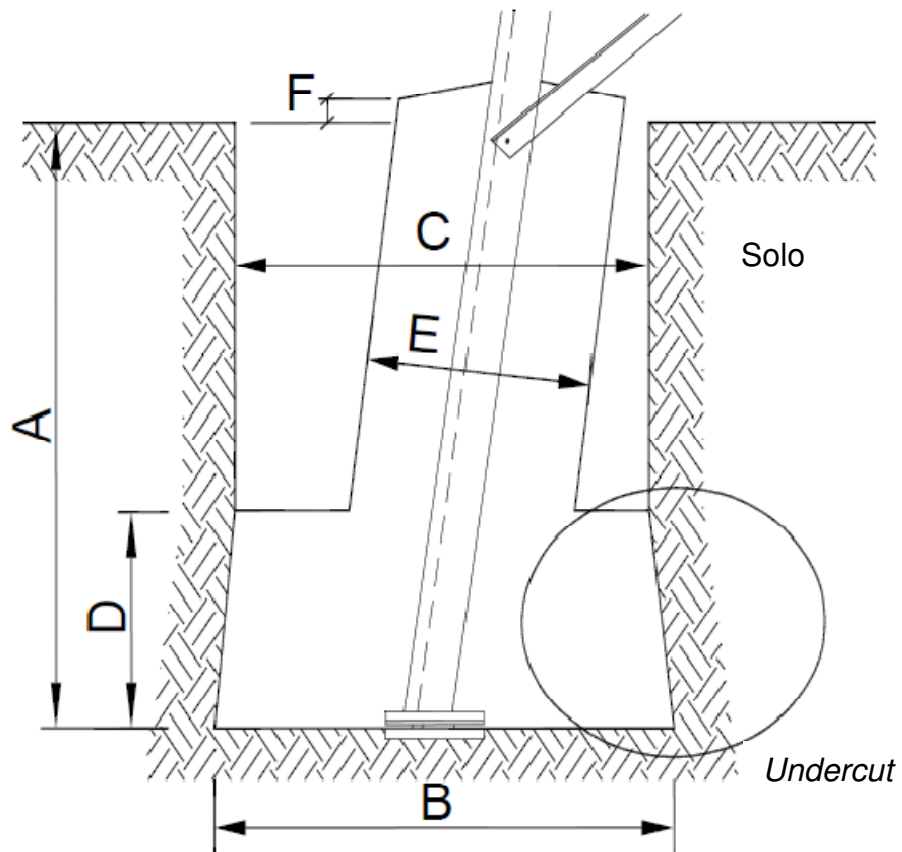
Fundação sapata tipo "undercut foundations"
